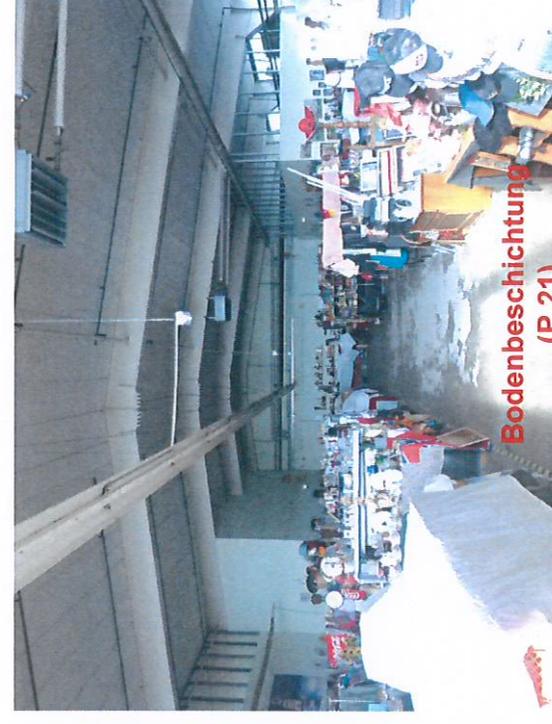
Halle 25 mit PCB-belasteter Stahlträgerfarbe (P 22)
